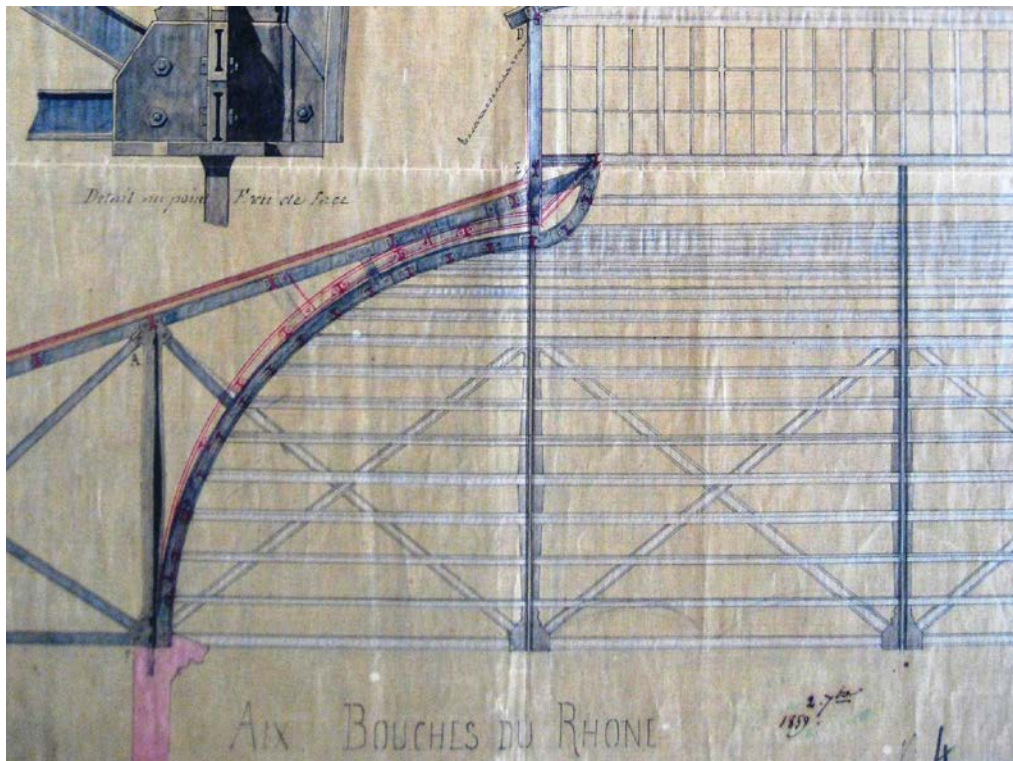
plan de coupe modifié © Archives départementales des Bouches-du-Rhône
